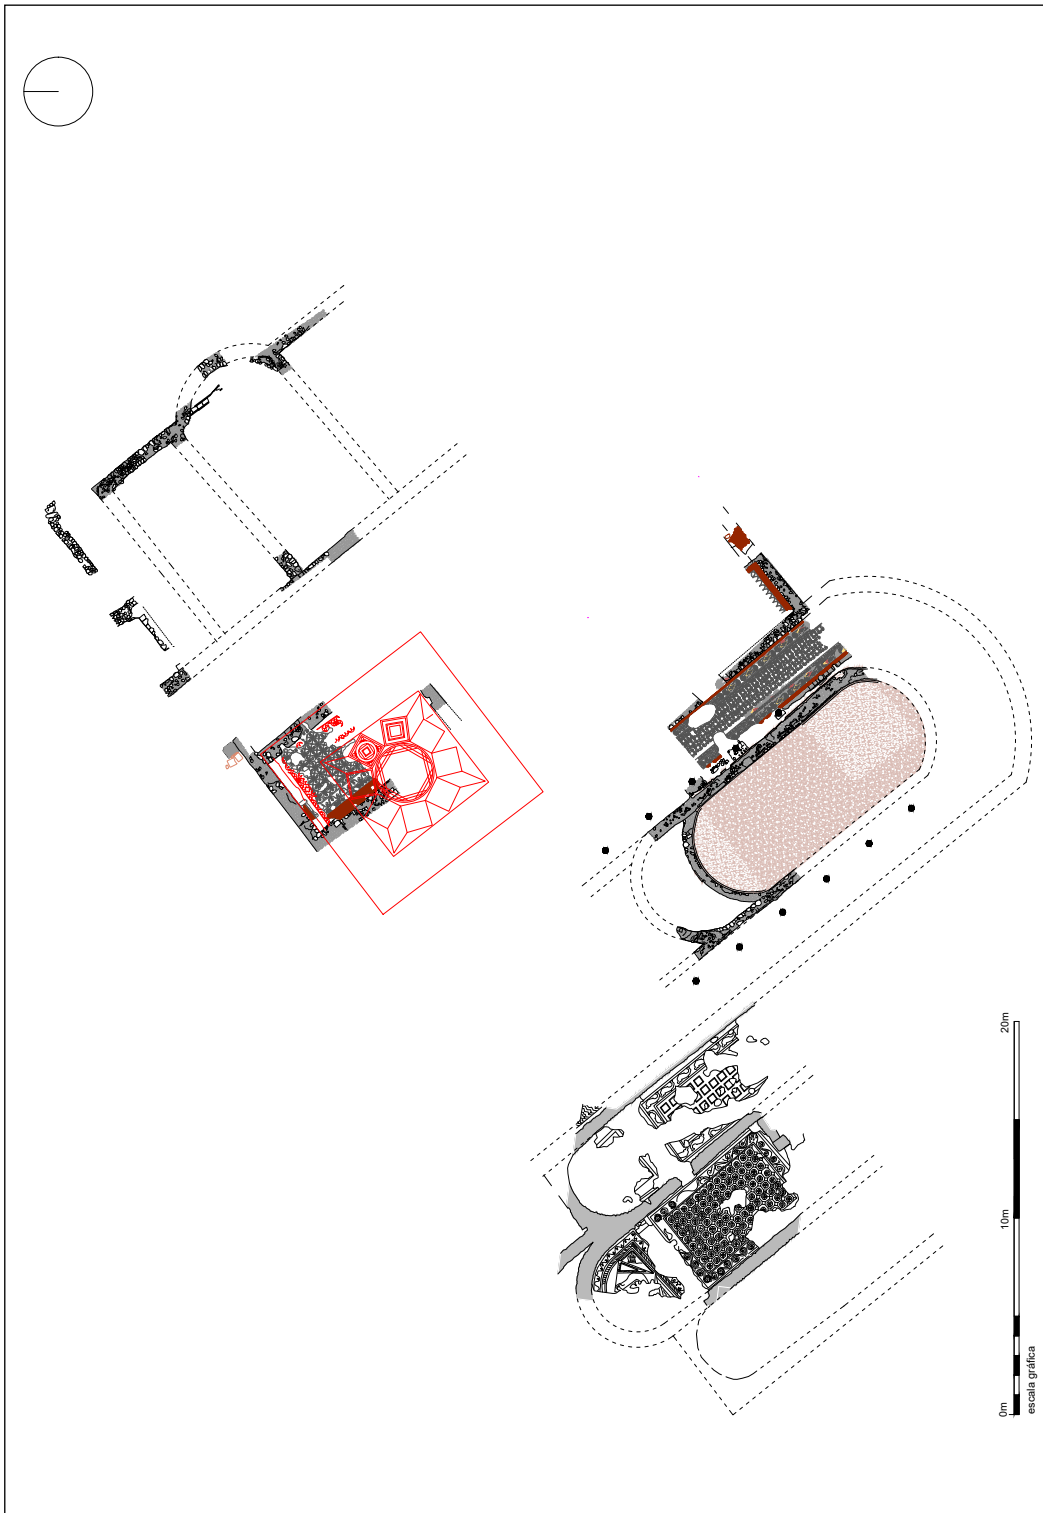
Reconstrucción hipotética de la planta de la villa.
